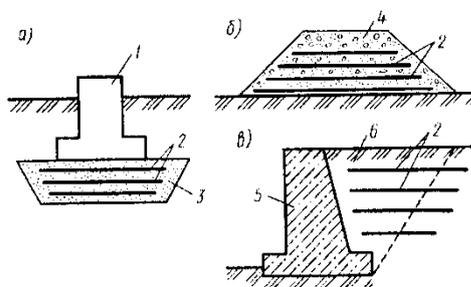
Армирование грунта в искусственном основании фундамента (а), при устройстве насыпи (б), при воздействии засыпок (в):
